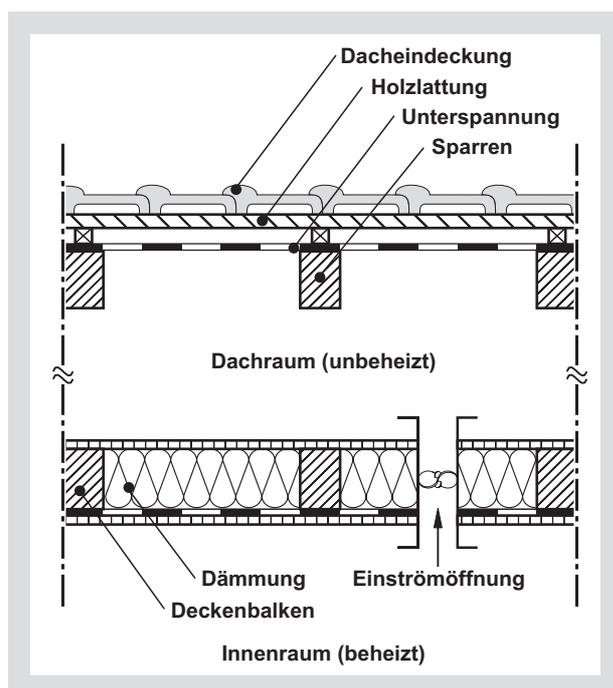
Prinzipieller Aufbau des Dachraumes und der Konstruktionsvarianten.
